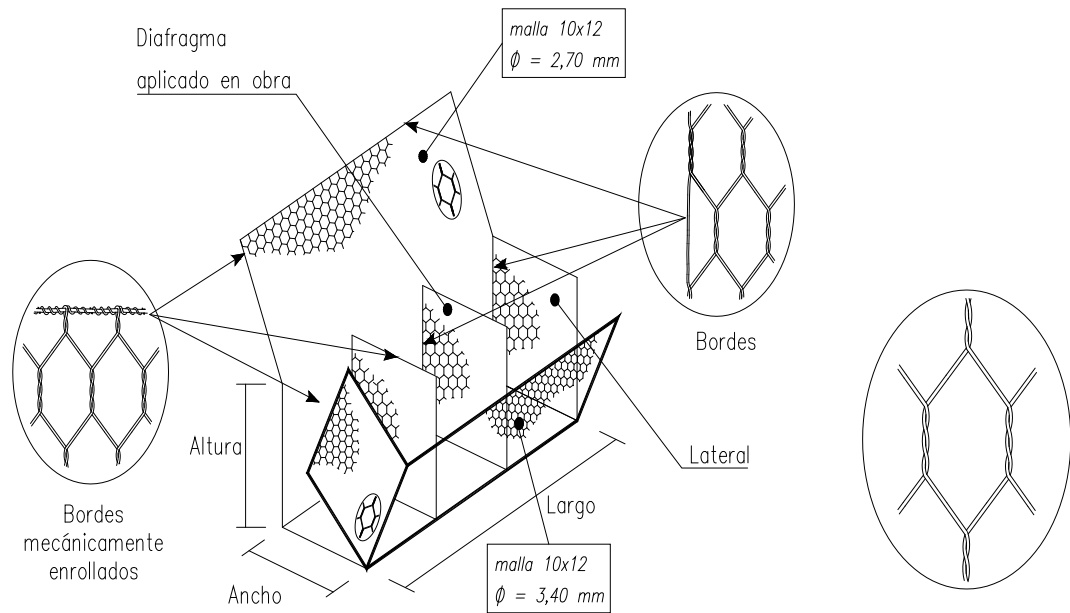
Elementos constituyentes de los Gaviones Tipo Caja Fuerte.
